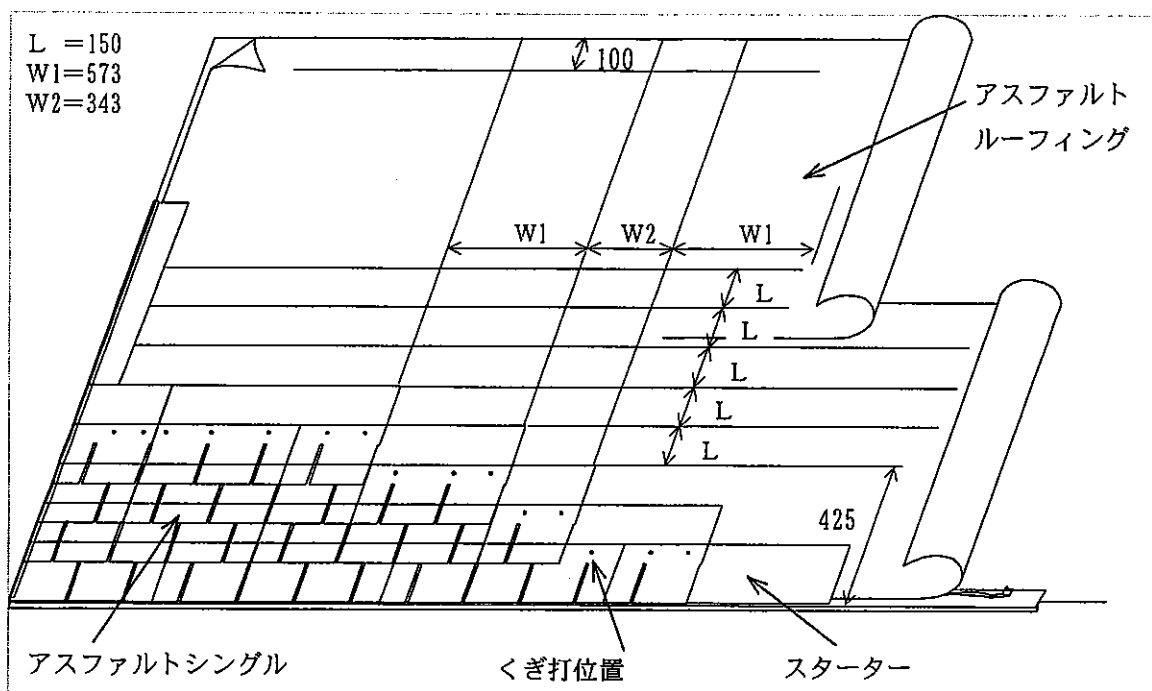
申請仕様の施工図 (アスファルトシングルの施工: 1タブ~4タブ)
